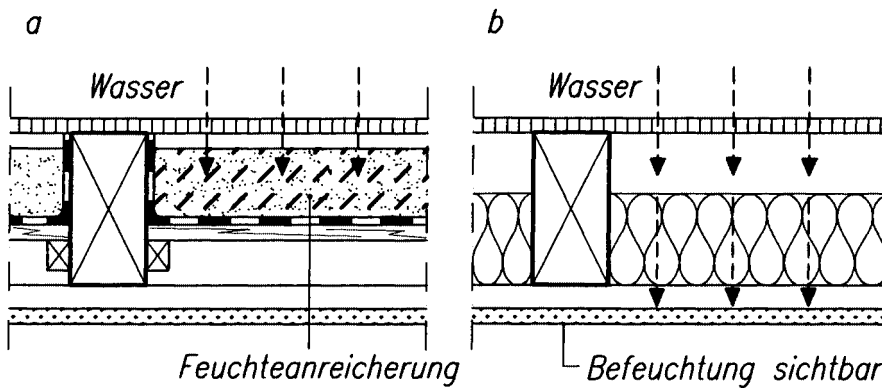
Beispiele für Konstruktionsprinzipien von Holzbalkendecken unter Naßbereichen, z.B. Bädern, Bewertung bezüglich im Deckenquerschnitt außerplanmäßig (ungewollt) vorhandener Feuchte, aus [4]
